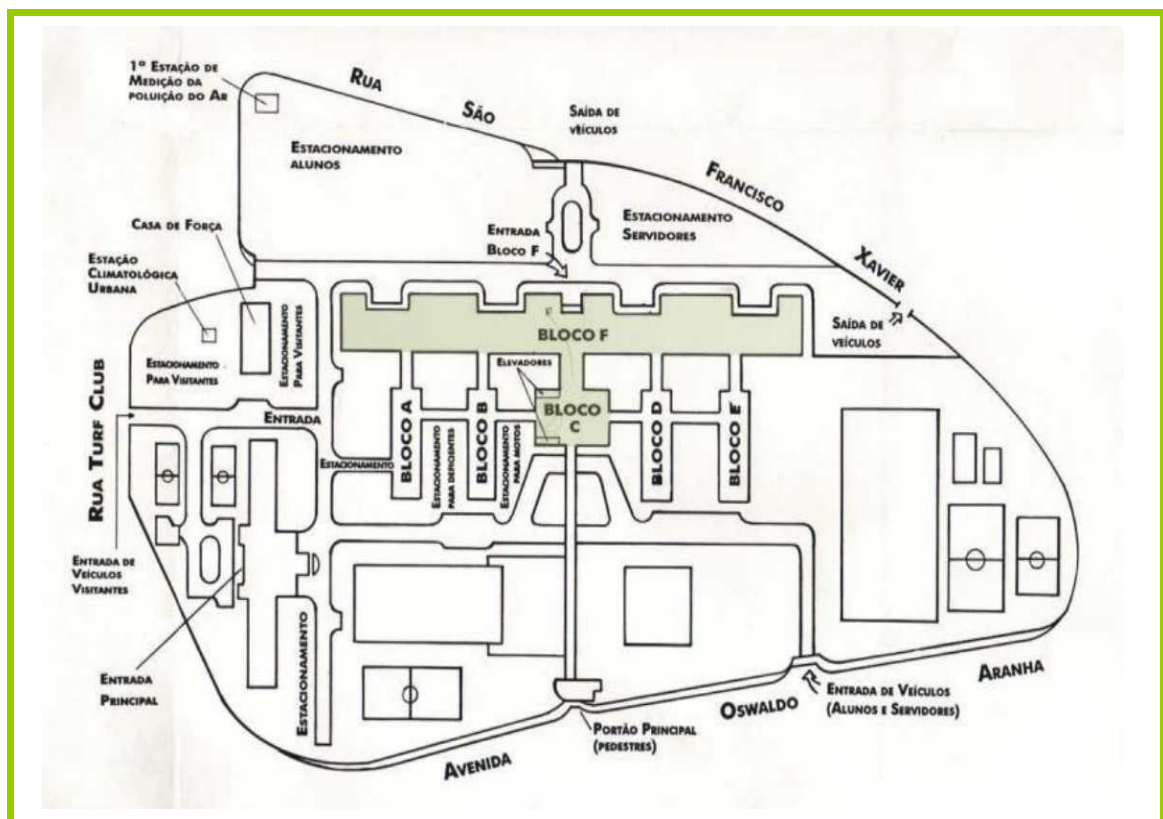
Planta de Situação Campus Francisco Negrão de Lima
